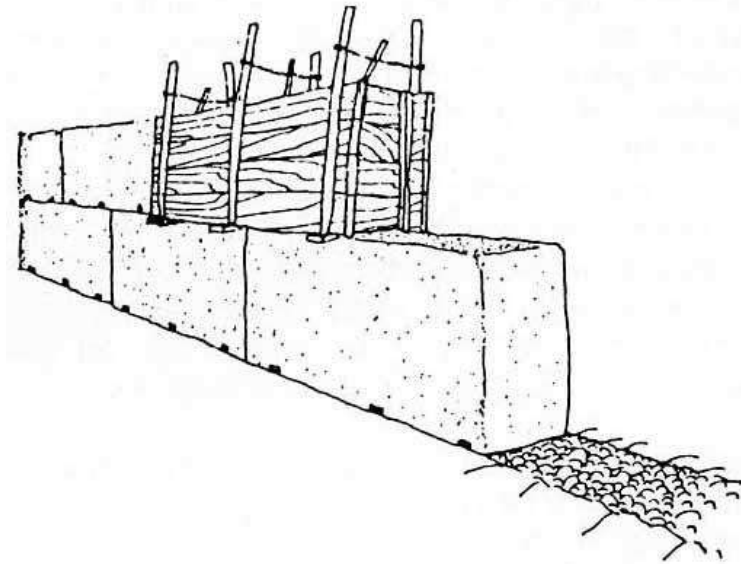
Detalle de la construcción con tapial (Fuente: Suarez, 2013)
